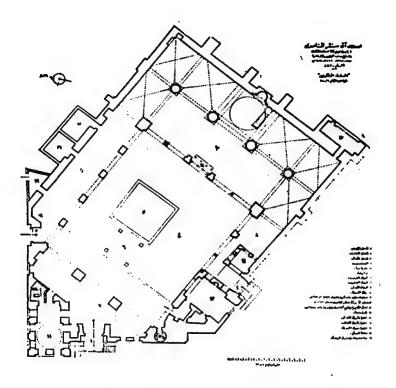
مسقط أفقى لمسجد وقبة الماس الحاجب وعن كلر ٥
